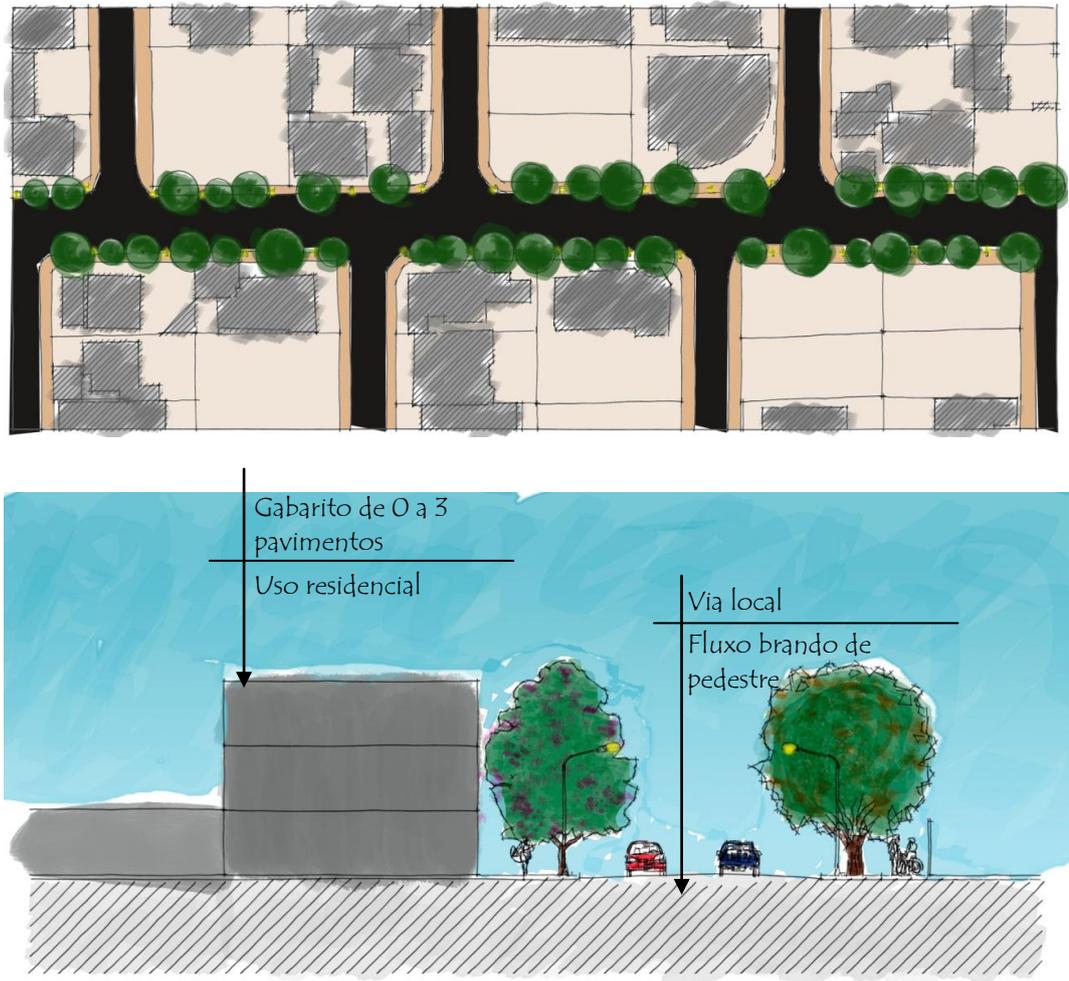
Modelo em planta e vista de arborização para a Engenheiro José Guilherme M. Varejão
